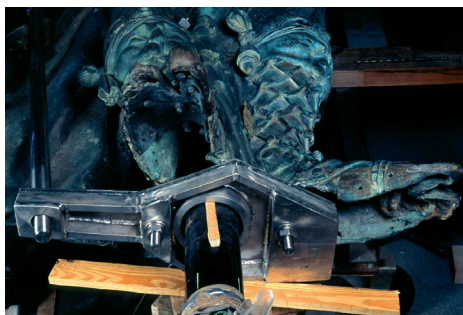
Detalles de la unión entre barra de la palma y travesaño intermedio en la estructura de 1770 y en la nueva estructura.
